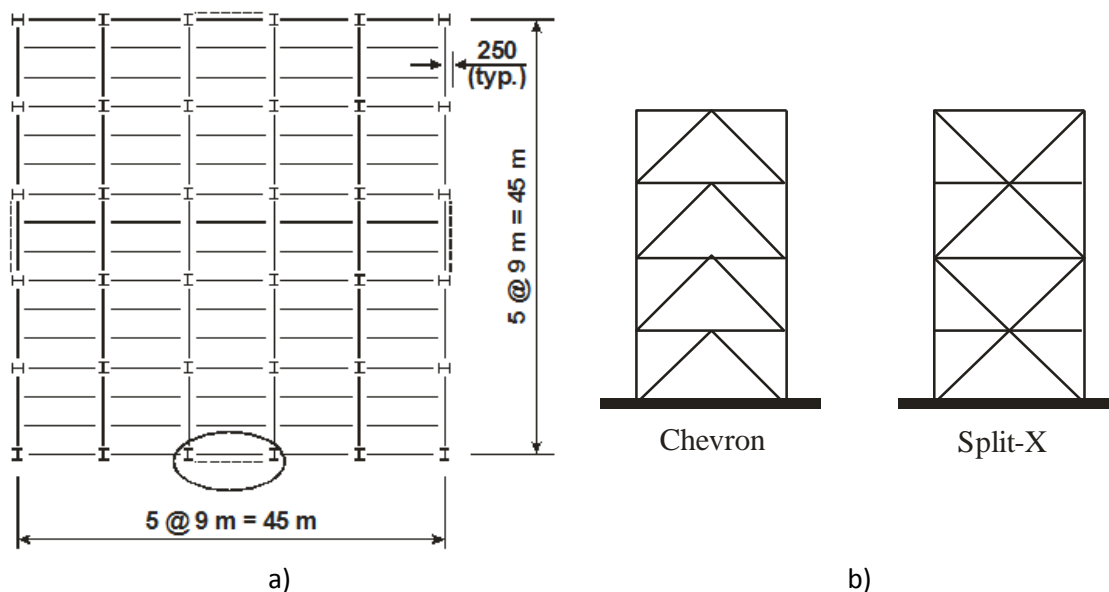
Bâtiment étudié; a) Vue en plan, b) Vue d'élévation
